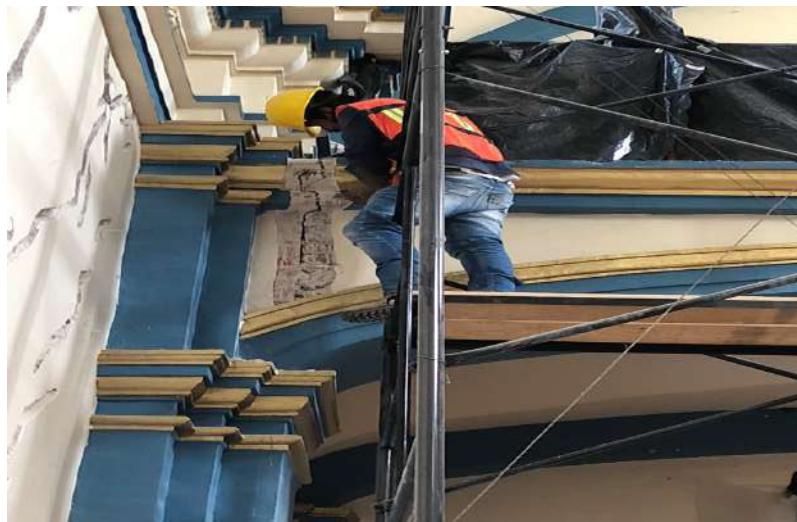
Grieta estructural en área de bóveda.
